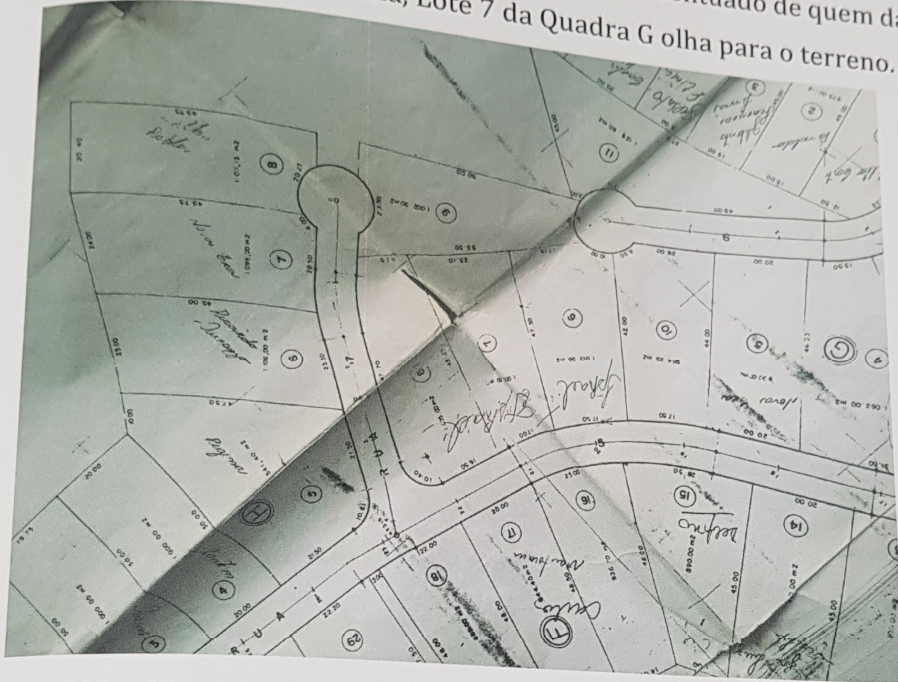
Vista da planta baixa do condomínio onde se situação o
